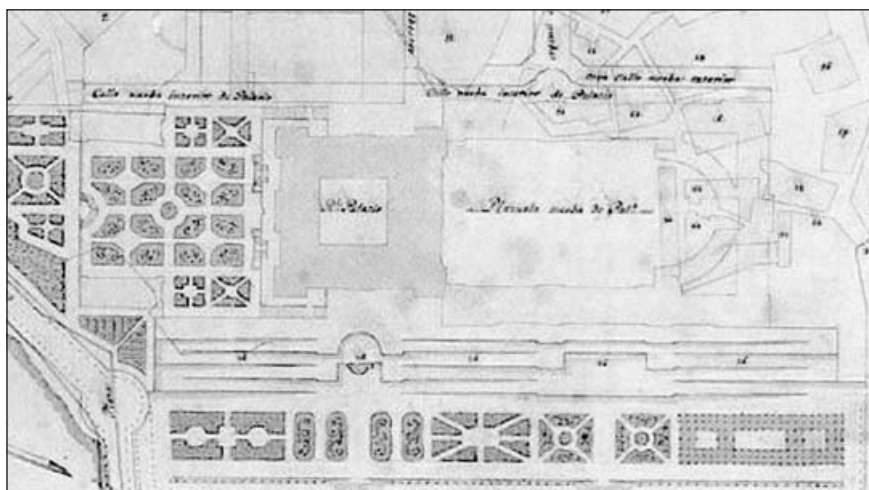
Sabatini: Plan General de Obras Exteriores de Palacio.
